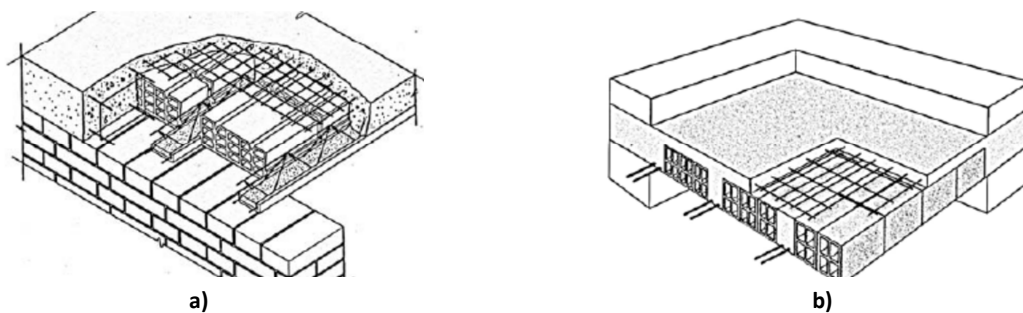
Rigidezza degli orizzontamenti: solai rigidi in laterocemento e travetti a) prefabbricati o b) gettati in opera e soletta collaborante armata
